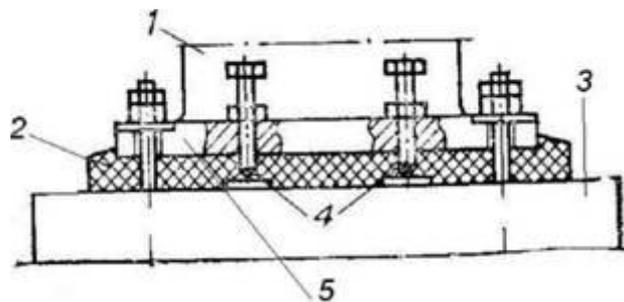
Схема установки оборудования на фундамент с опиранием на бетонную подушку:
